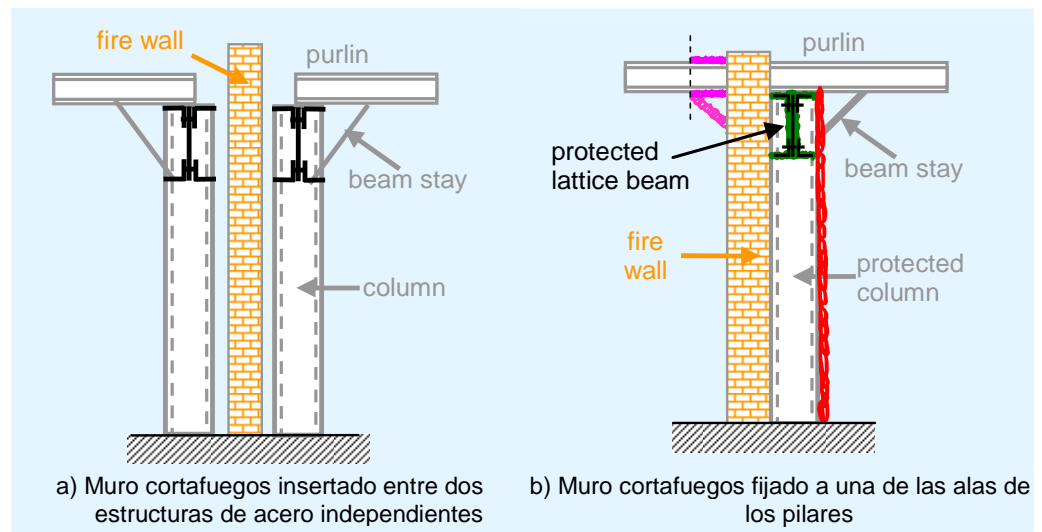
Diseño de detalle cerca de un muro cortafuegos paralelo a los pórticos con vigas en celosía
